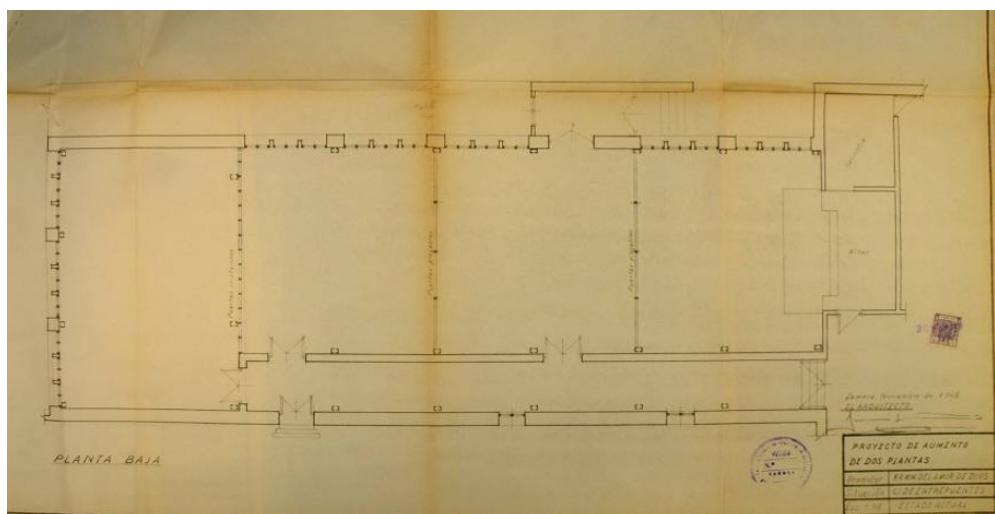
Plano de planta. AHPZa. DPV. 105/10.
